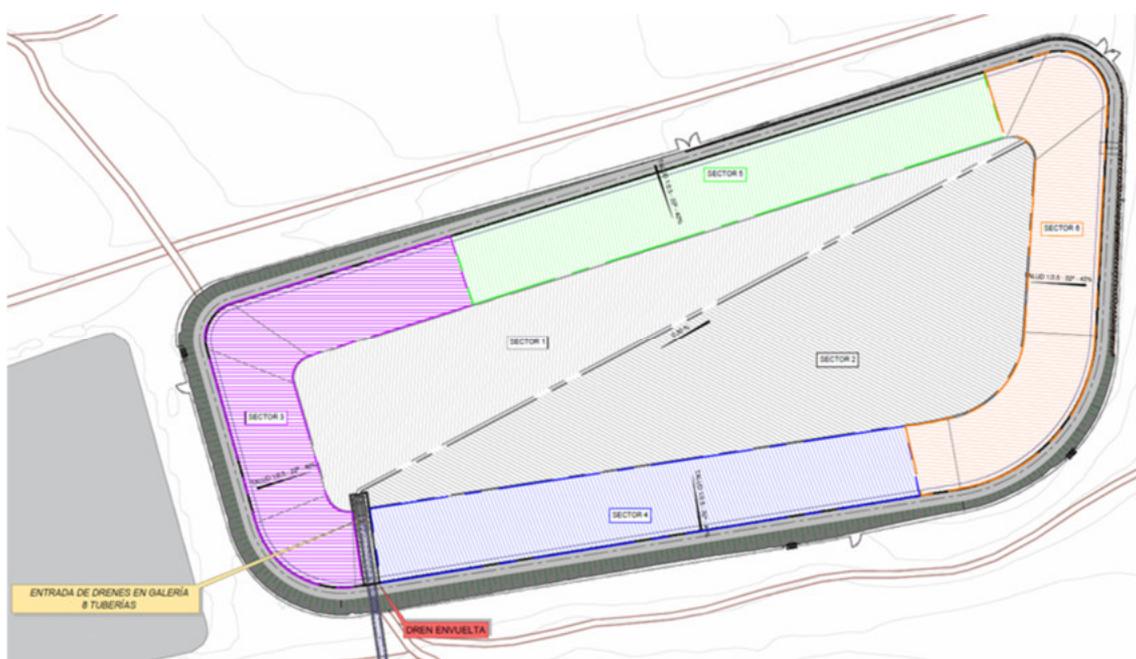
División en los 6 sectores de drenaje. Fuente: Elaboración propia
